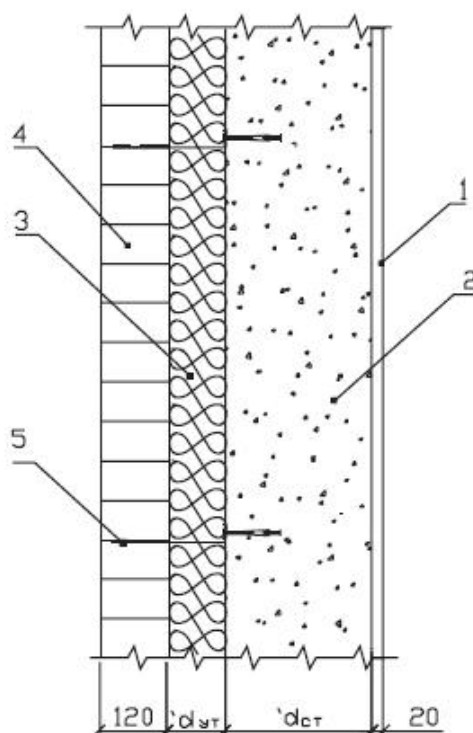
Стена из блоков с теплоизоляцией из плит марки "ТЕРМО" в качестве среднего слоя конструкции с облицовкой лицевым кирпичом (новое строительство).
